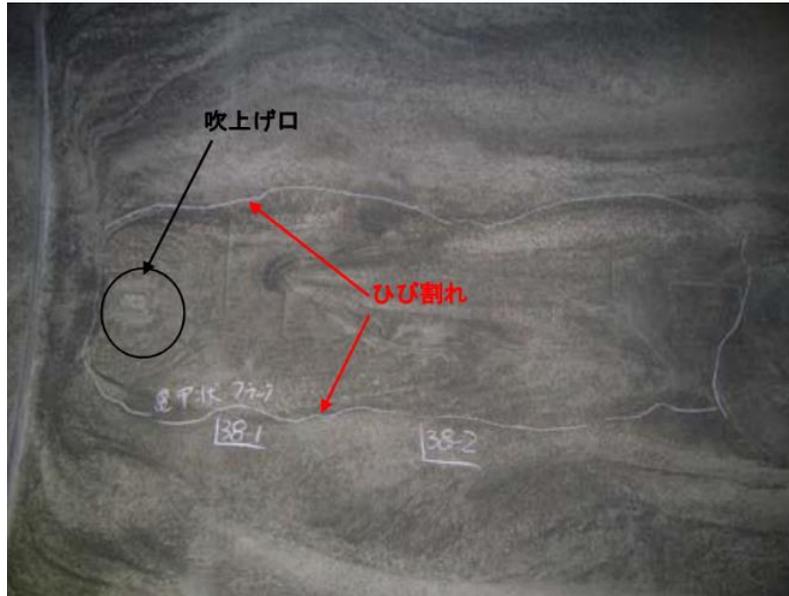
天端部に生じた色むらに沿ったひび割れ
